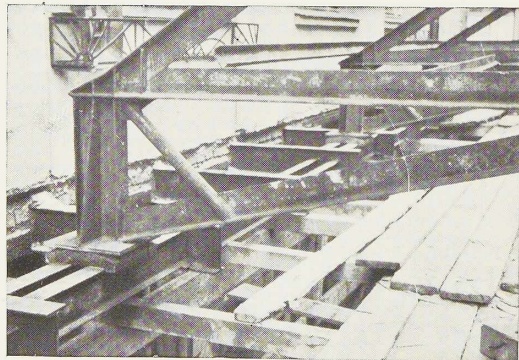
Vue de l'assemblage des supports des fermes paraboliques.
